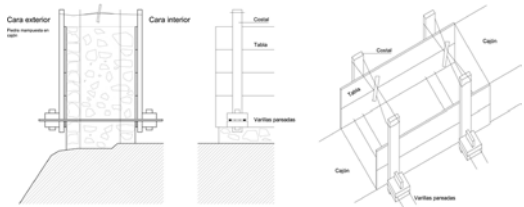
Detalle del sistema constructivo con varillas pareadas.
